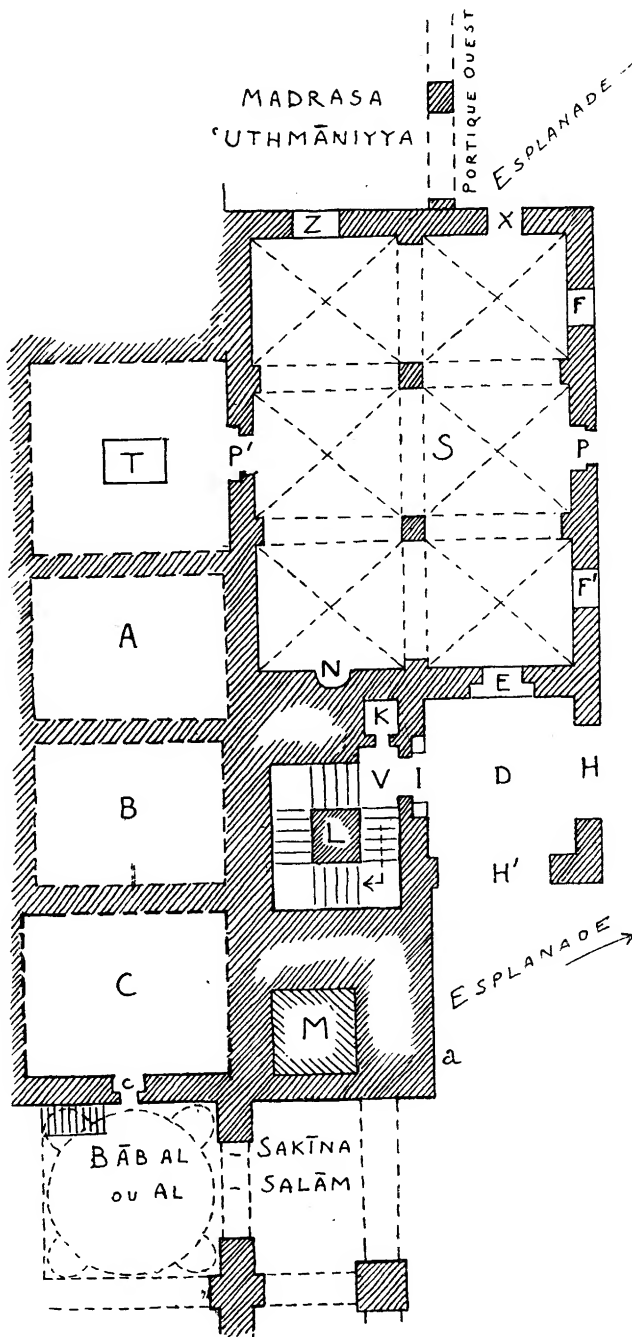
Plan de l'Ashrafiyya (rez-de-chaussée).
